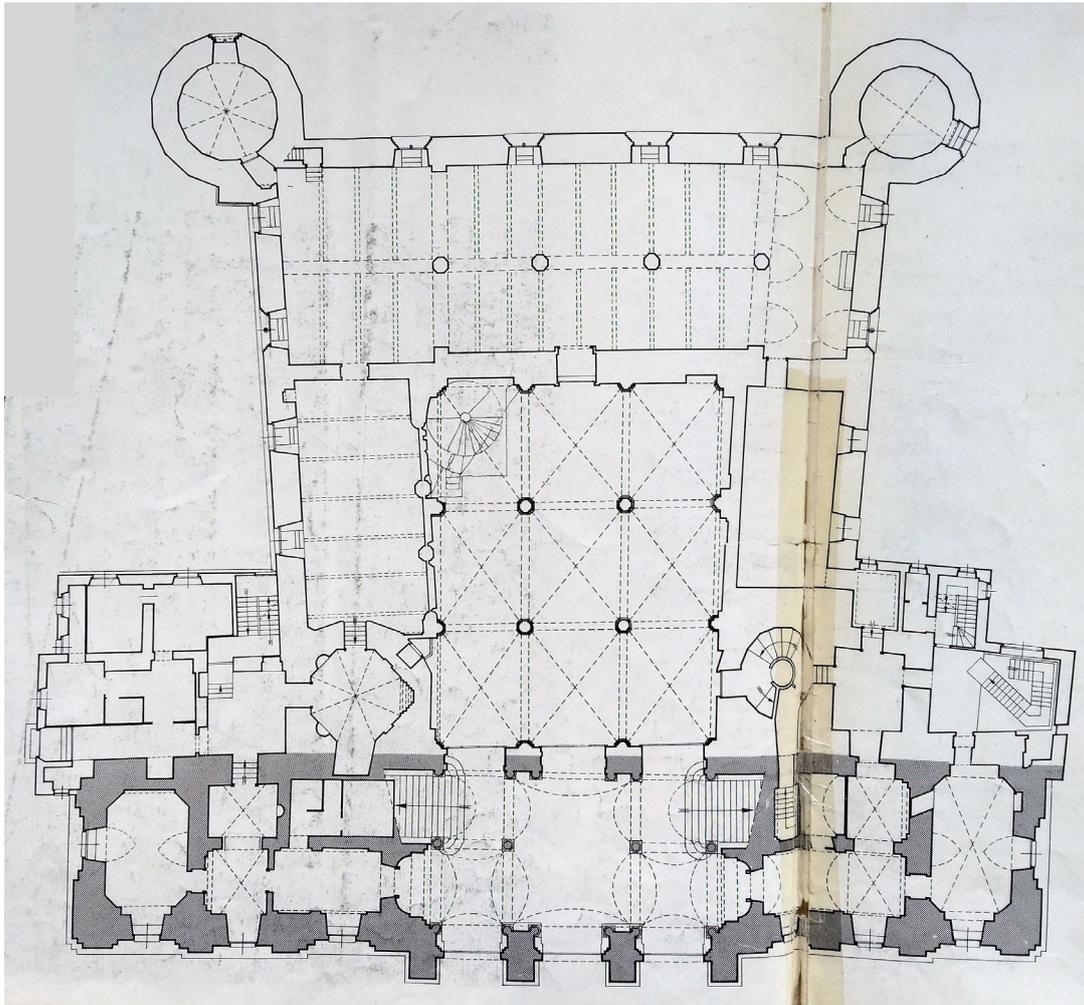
Palazzo Madama, pianta generale del piano terreno: le zone a retino indicano le strutture murarie juvarriane a sostegno dello scalone (da Gritella, 1992, pp. 431-432).
